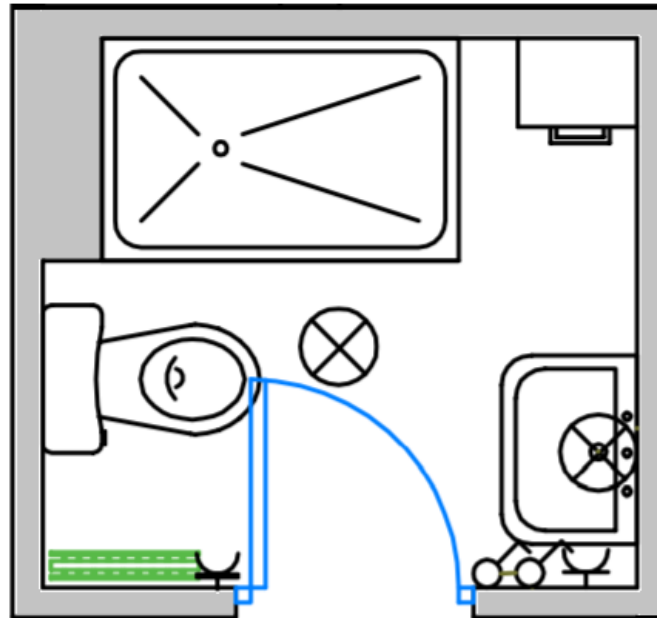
Plano de planta del baño 2. Fuente: Elaboración propia
